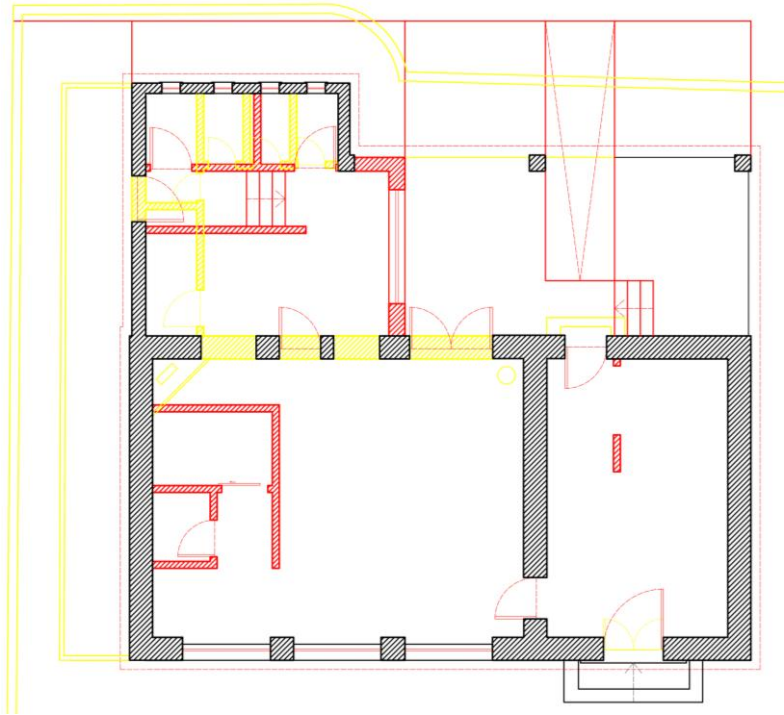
| Planta Piso Térreo Pré-existência (Vermelhos e Amarelos)
